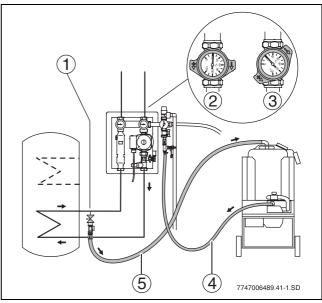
Lavagem de um sistema padrão com permutador de calor Ø > DN 25 - aqui: lavagem sob o grupo de circulação
